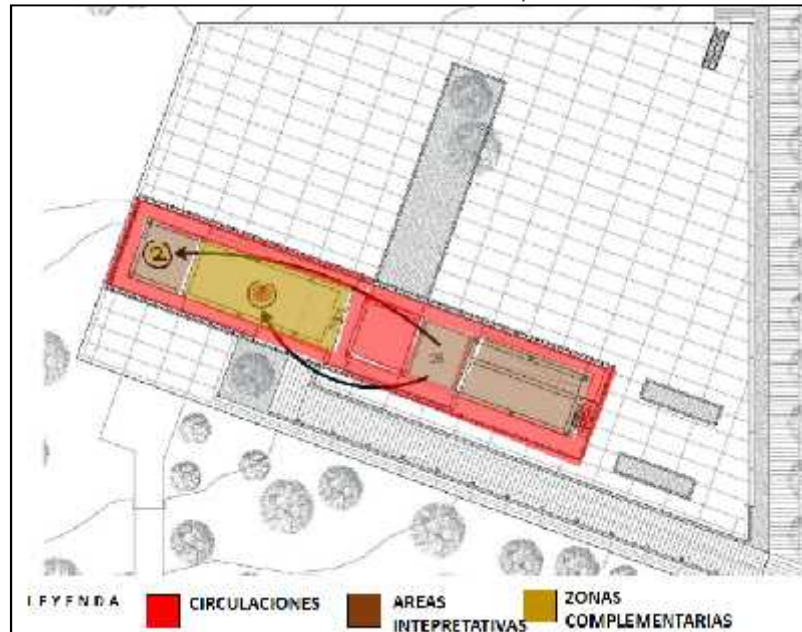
Planta Baja Centro de Interpretación de la Naturaleza
